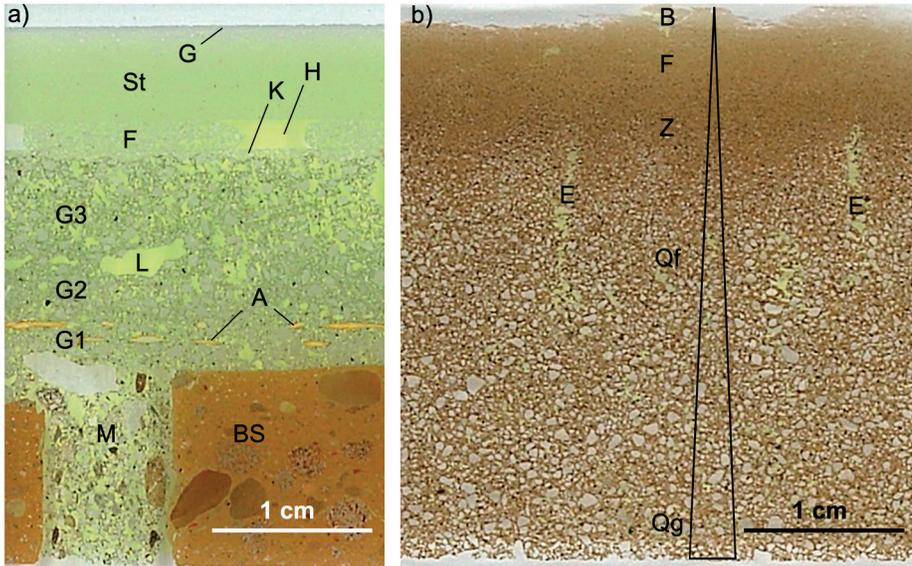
a) Wandaufbau mit Backsteinmauerwerk (BS: Backstein, M: Mauermörtel), 3 Lagen Grundputz (G1: mit 2 Lagen Armierungsgewebe A, G2: dichter Grundputz, G3: Grundputzschicht mit zahlreichen Lunkern L, worin eine schadhafte Abscherung stattfand), Fliesenkleber (K: Kratzspachtelschicht, F: Floatinglage mit dazwischenliegenden Kämmhohllagen H) und einer glasierten (G) Steingutfliese (St).
